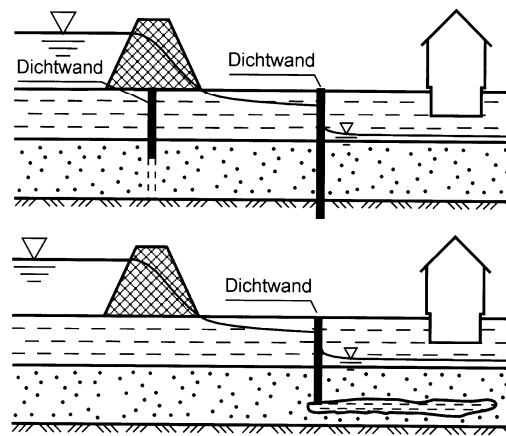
Schutz gegen Drainwasser durch vertikale Untergrundabdichtung
